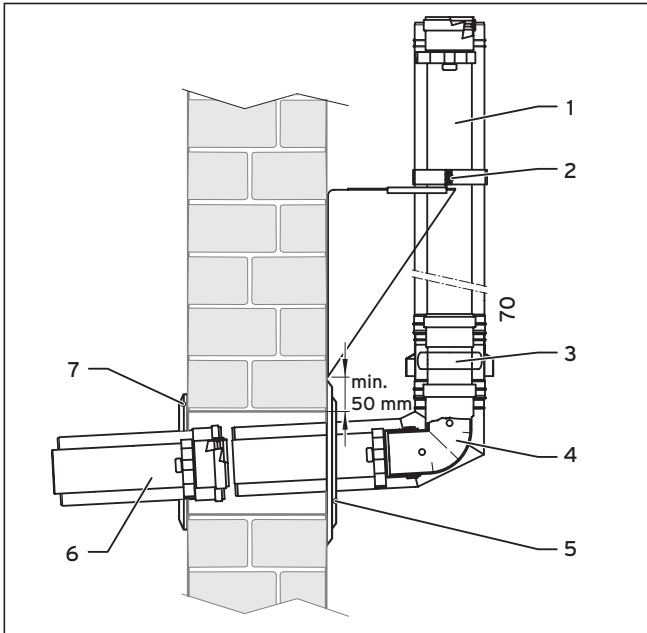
Montage du raccord pour le conduit du murextérieur
